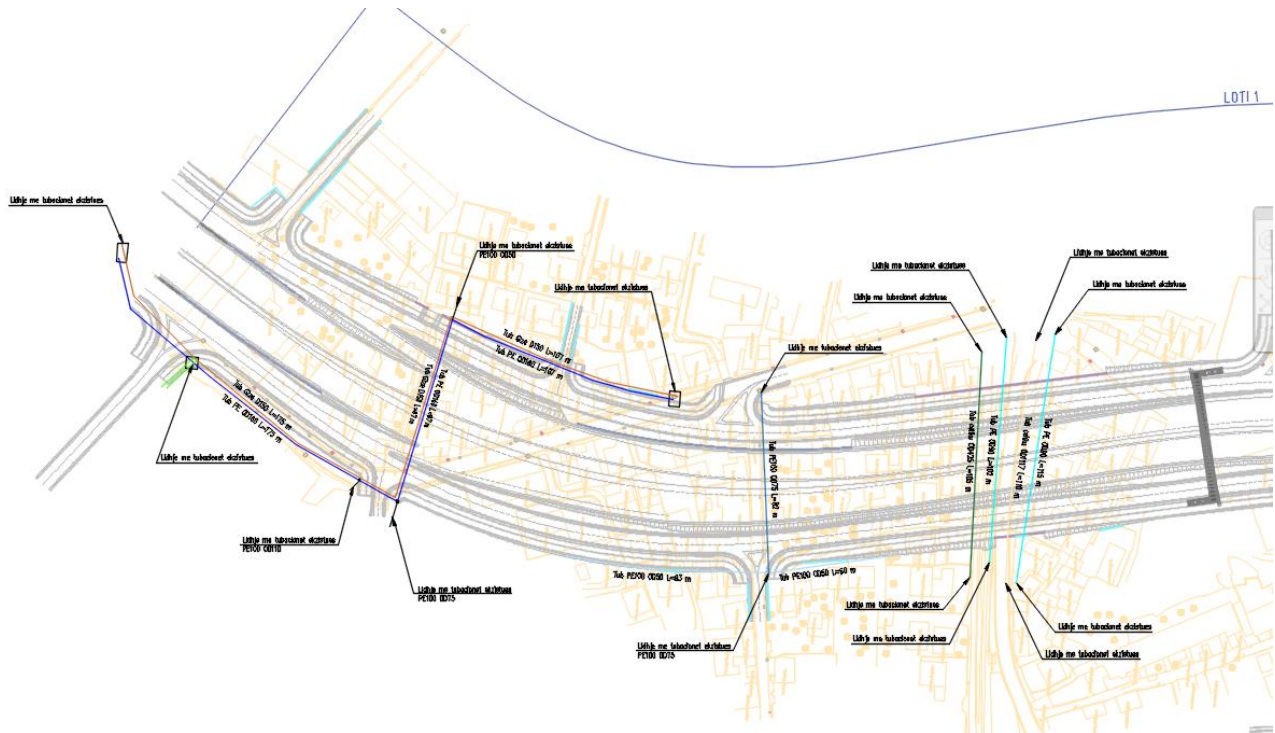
Fragment nga plani i zevendesimit te rrjetit te ujesjellesit
